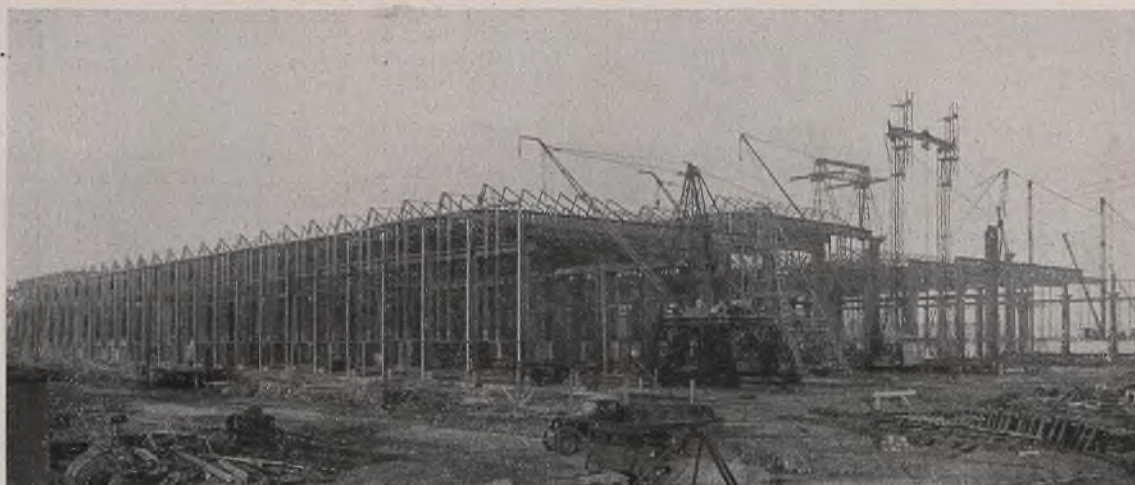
Baustelle mit den verschiedenen Montagegeräten.
